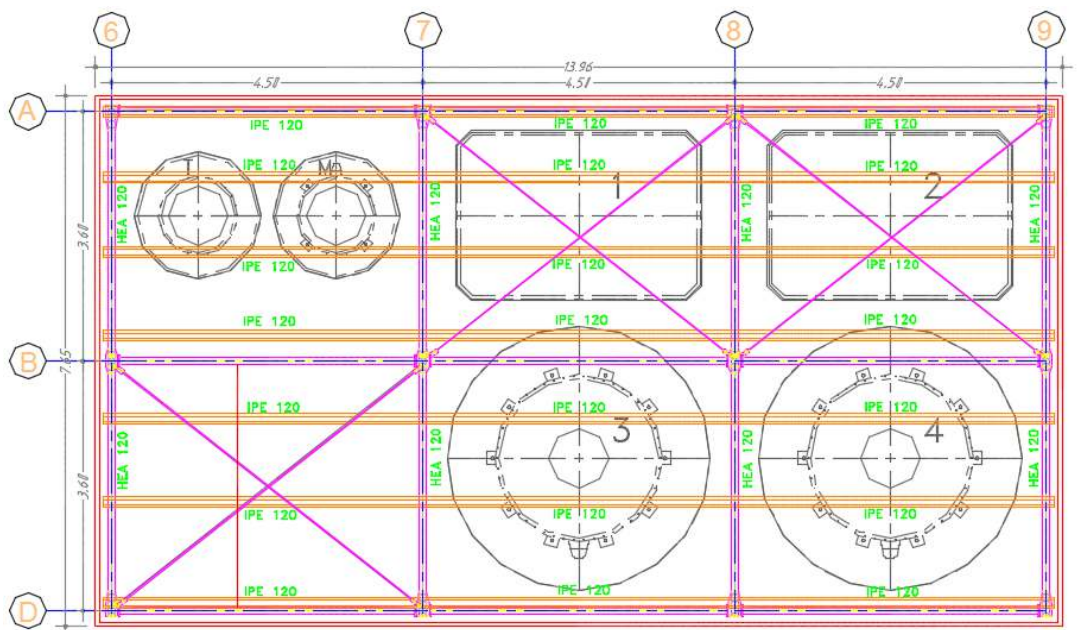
Vue en plan du Plancher Niveau +17.60
